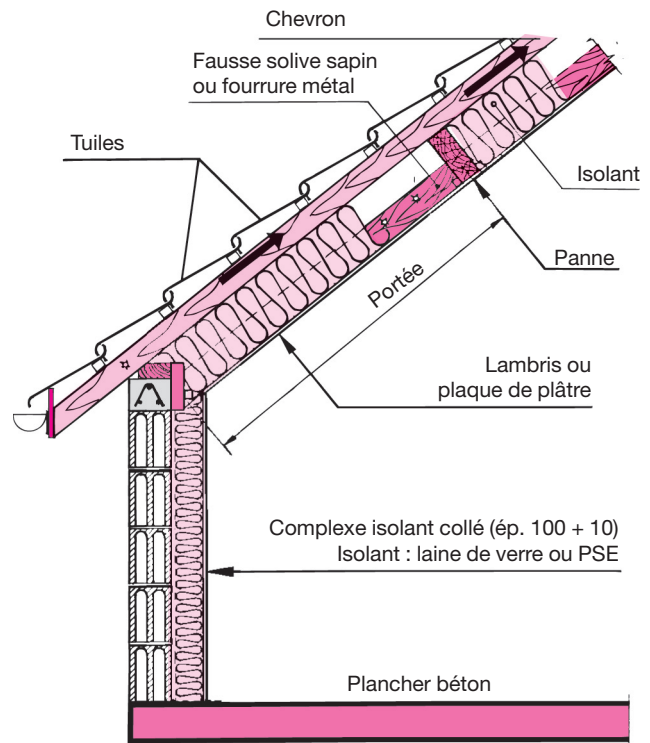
Complexe de doublage sur mur de rive et laine de verre en rampant avec habillage plaques ou lambris
